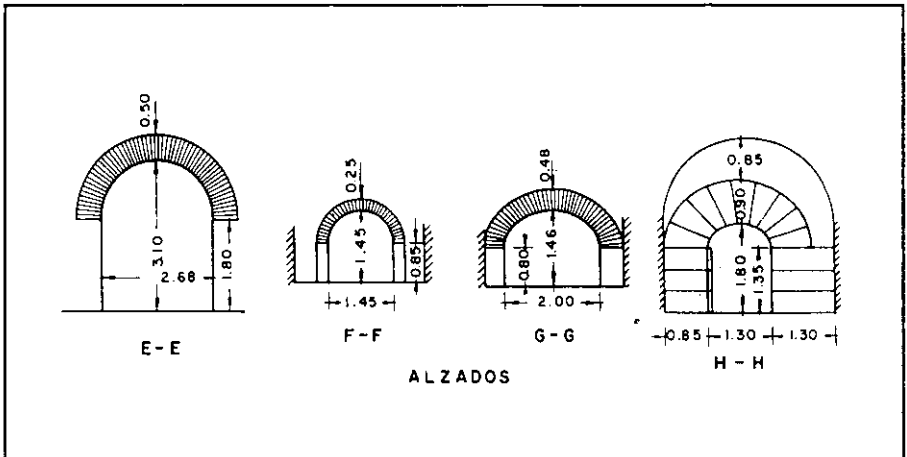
Alzados correspondientes a la parte de la Cueva situada en la planta baja de la calle de San Ginés núm. 2 (según García-Diego).
